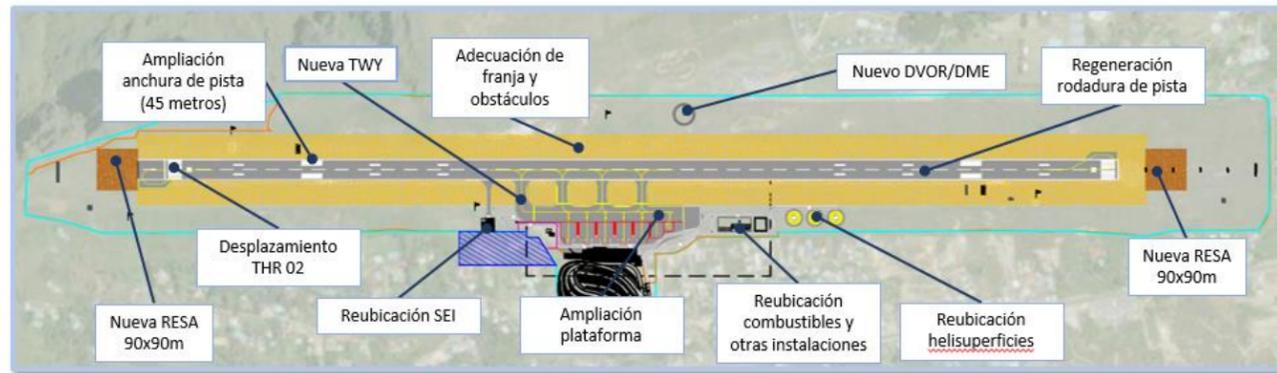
Planta general del estado final de las instalaciones del aeropuerto (Fuente: e elaboración propia)
